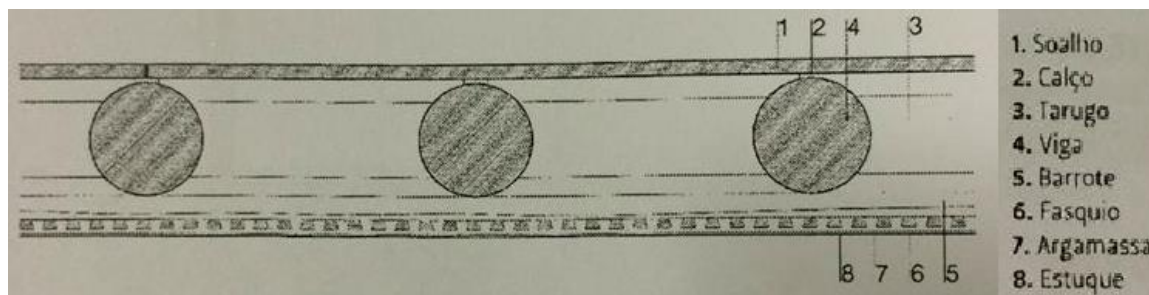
Pormenor construtivo do pavimento de madeira / teto [6]
